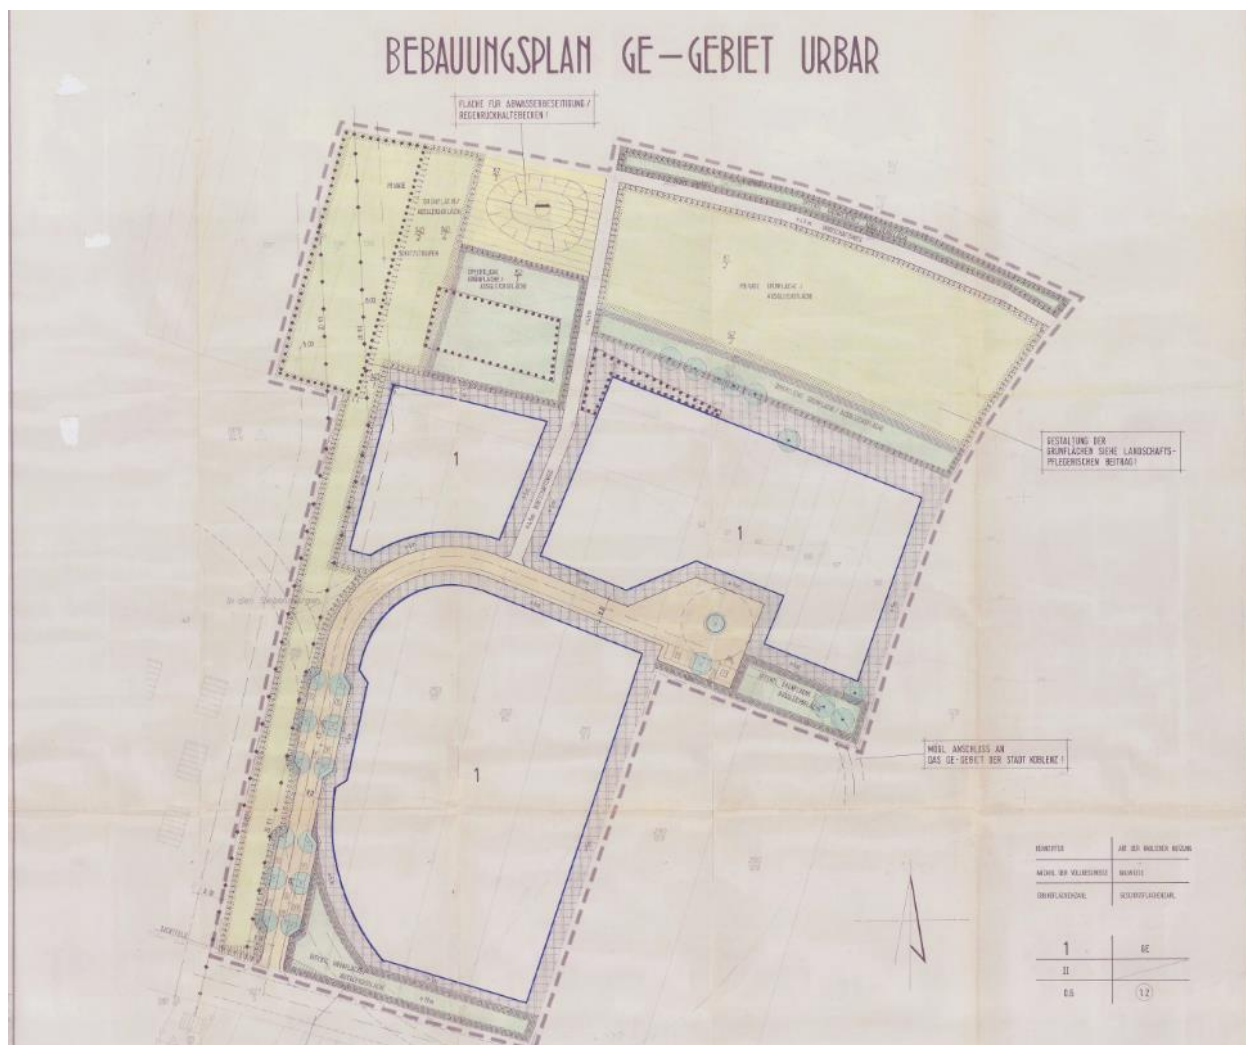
Bebauungsplan Gewerbegebiet Urbar (Darstellung VG Vallendar 2021)
